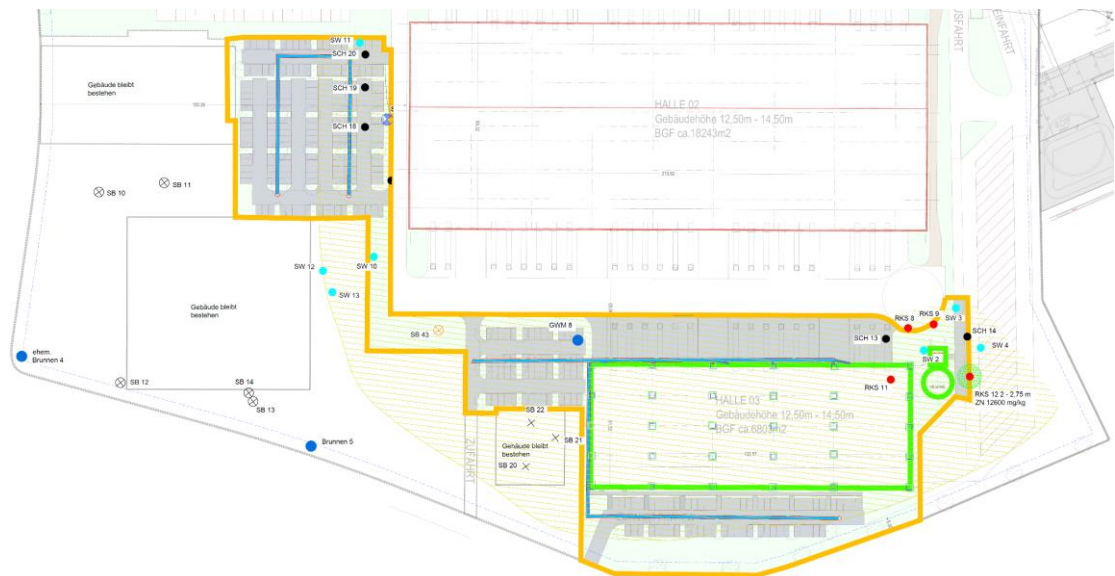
Bauabschnitt 3; Neubau Halle 3
